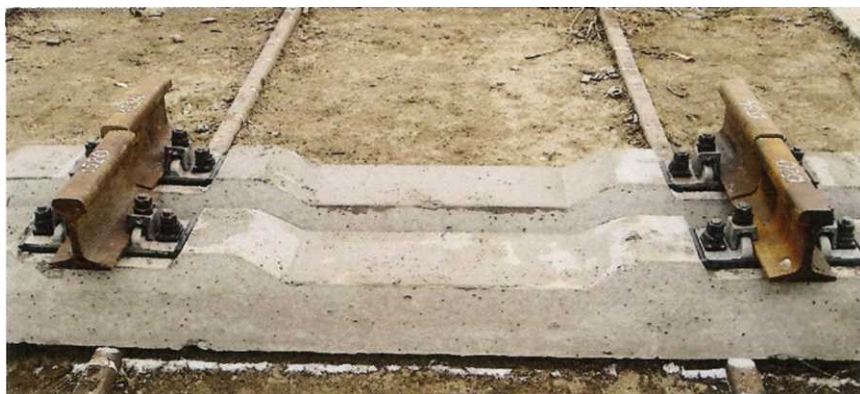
СКД65 Б – скрепление для железобетонных брусьев
